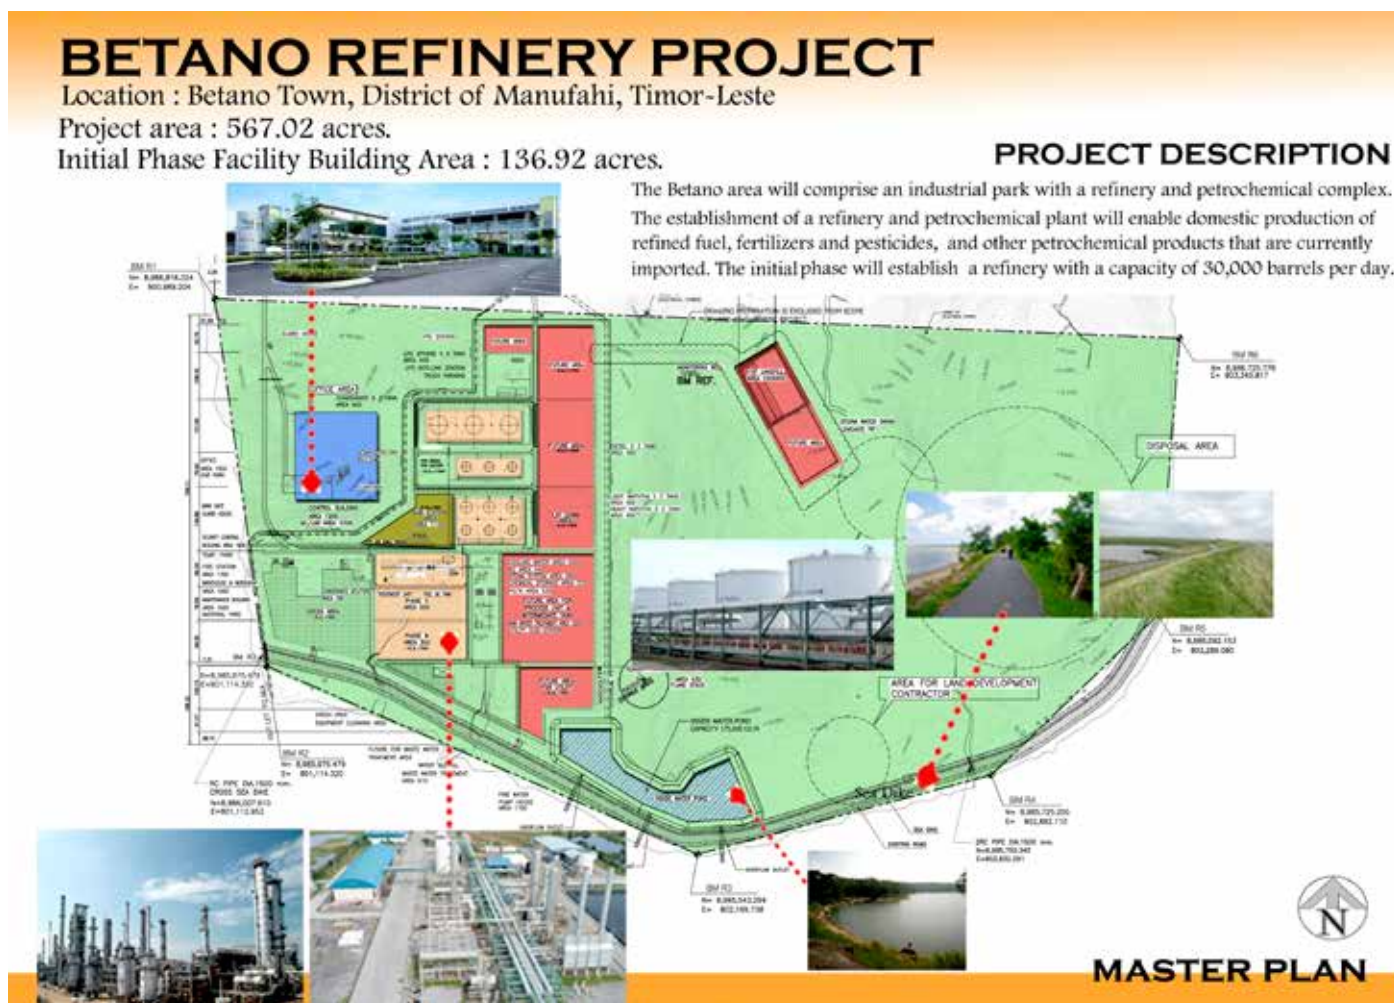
Master Plan do projeto da Refinaria de Betano
